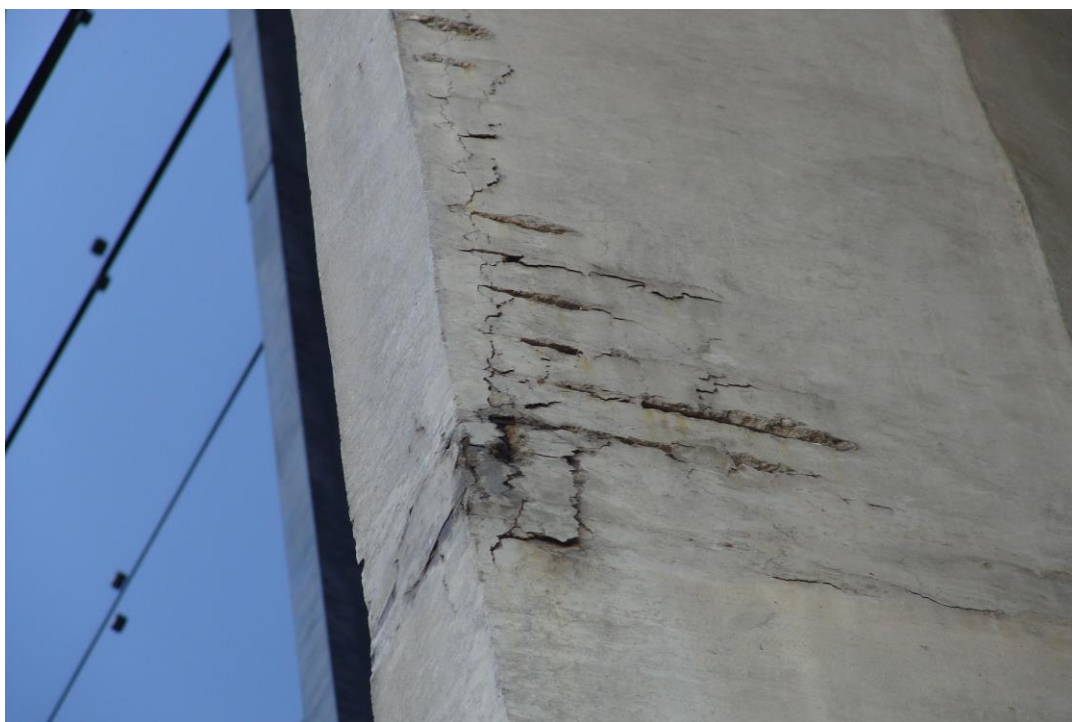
Armadura exposta pilar P14 (3º pavimento) (19/11/2013)
